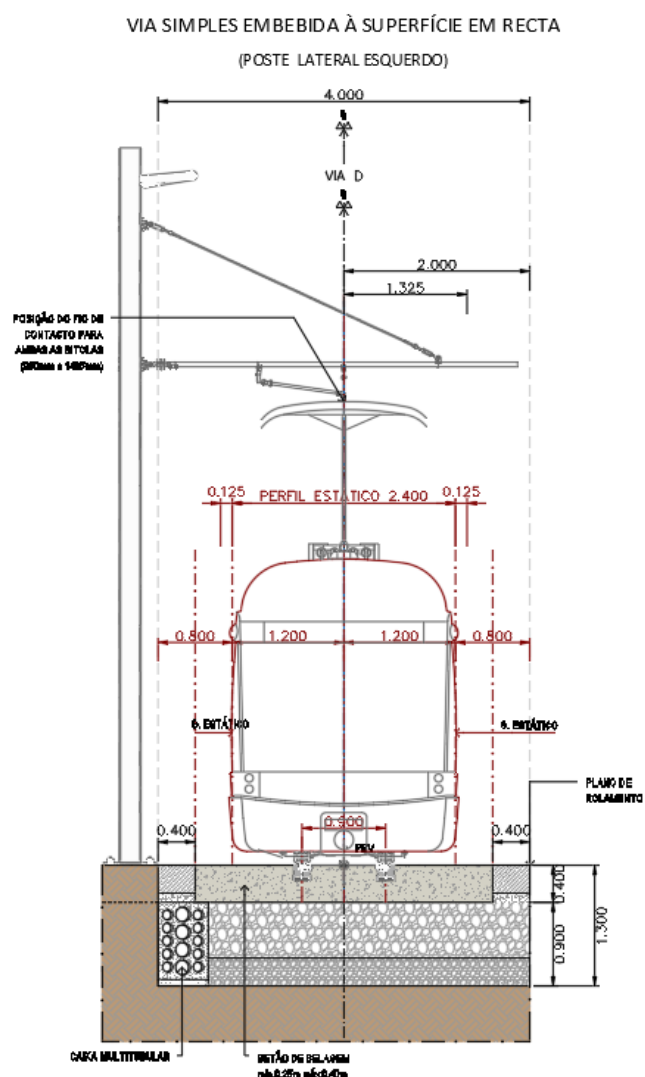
Perfil transversal tipo - Via simples lateral
